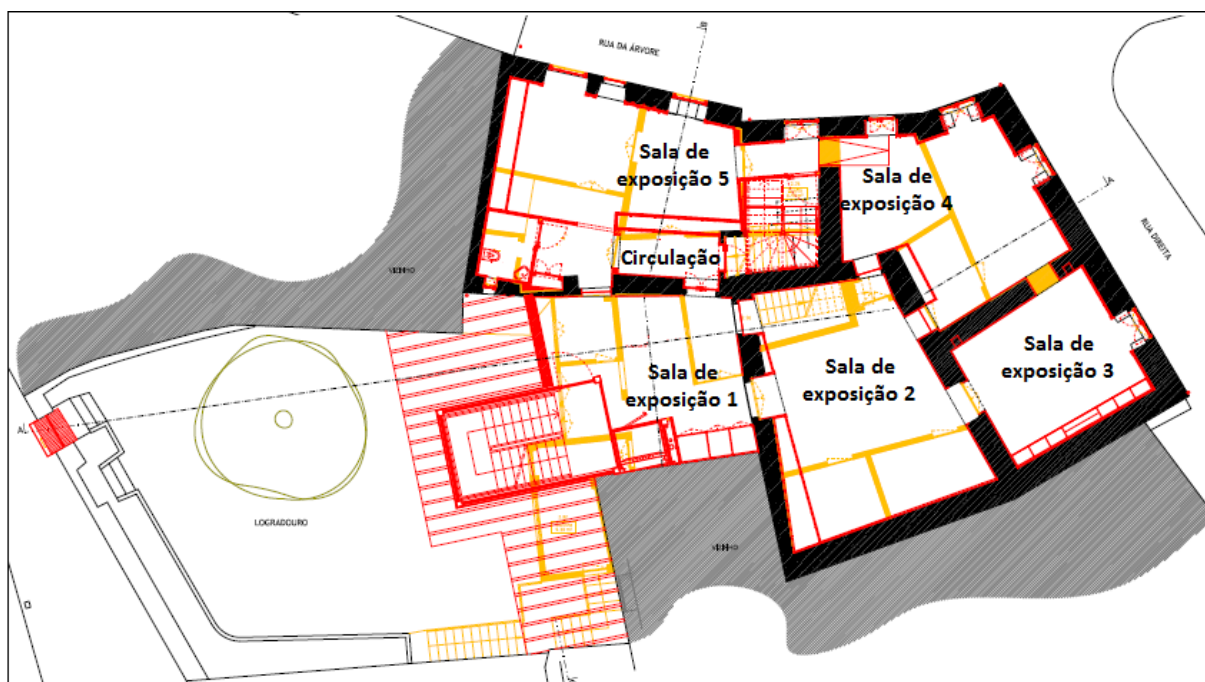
Planta do Piso 1 do edifício 3 em estudo
